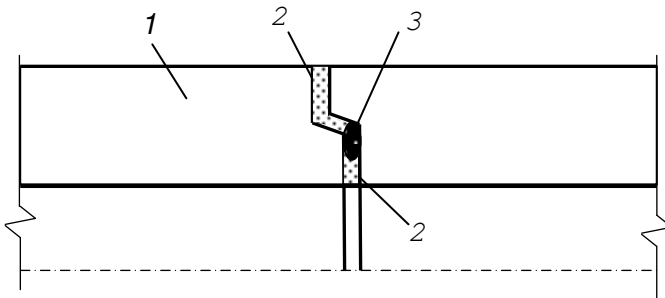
Фальцеві з'єднання бетонних і залізобетонних труб:
